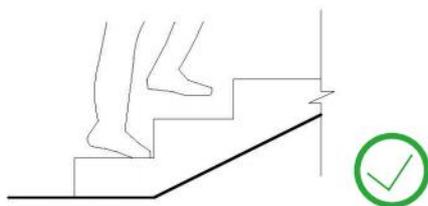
(6) 扶手示意图 (单位: mm)
